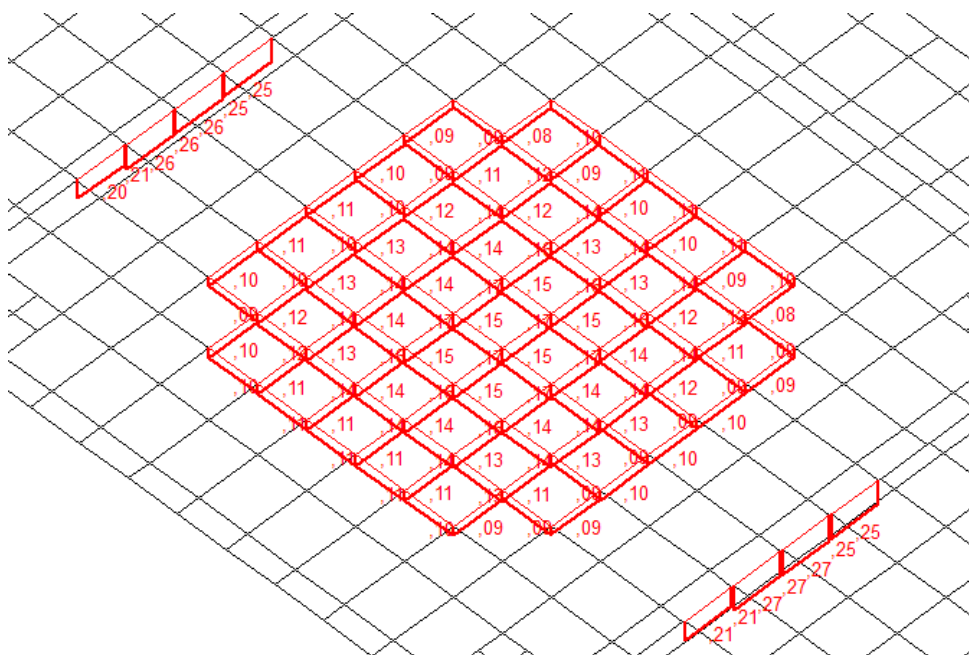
Ampliação da abertura de fissuras no pavimento PT1 da Solução de Laje Nervurada com abertura máxima de 0,27 mm
